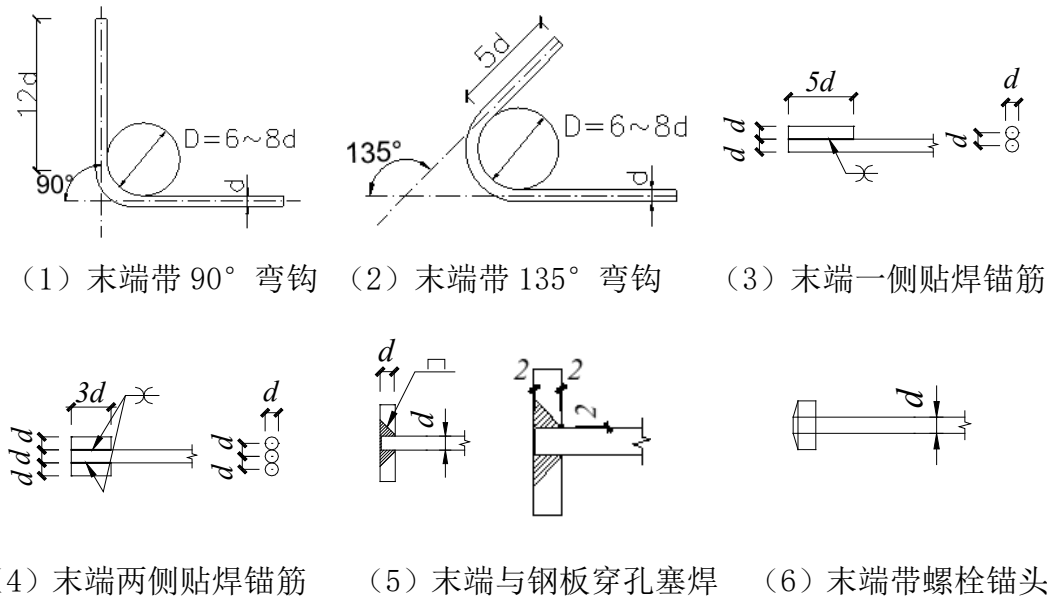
钢筋弯钩和机械锚固的形式与技术要求
